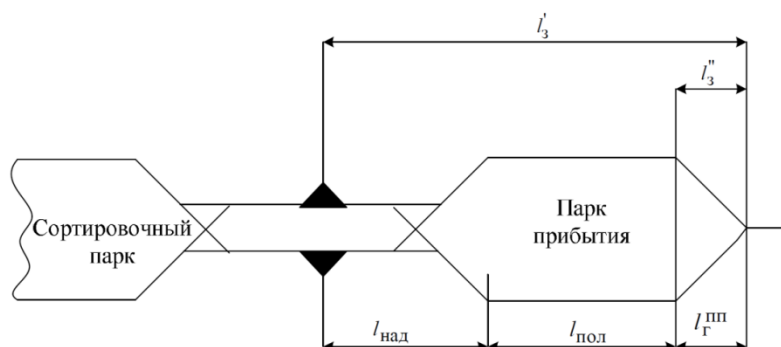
Схема расположения парка приема и сортировочного парка
